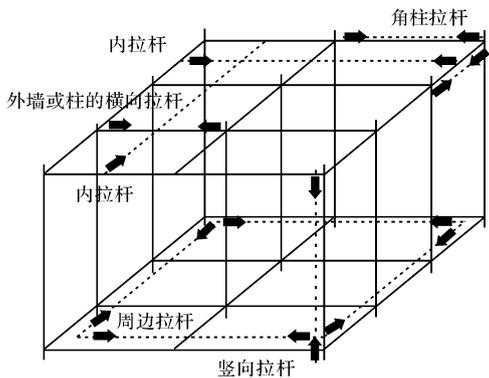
钢筋混凝土框架结构抗连续性倒塌拉杆设置
